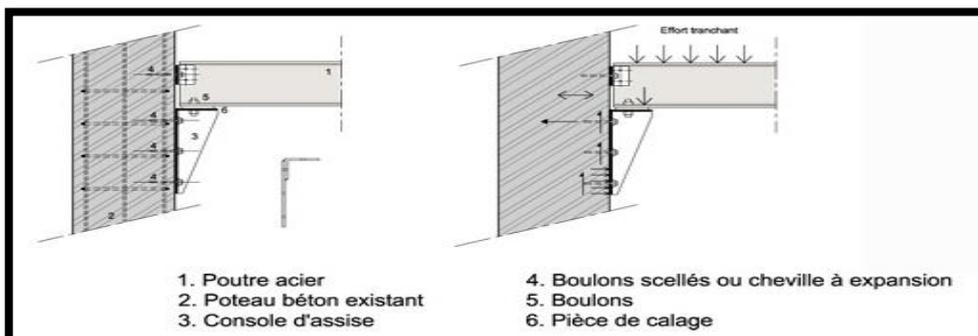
schéma d'un détail d'attache d'une poutre sur un poteau existant
